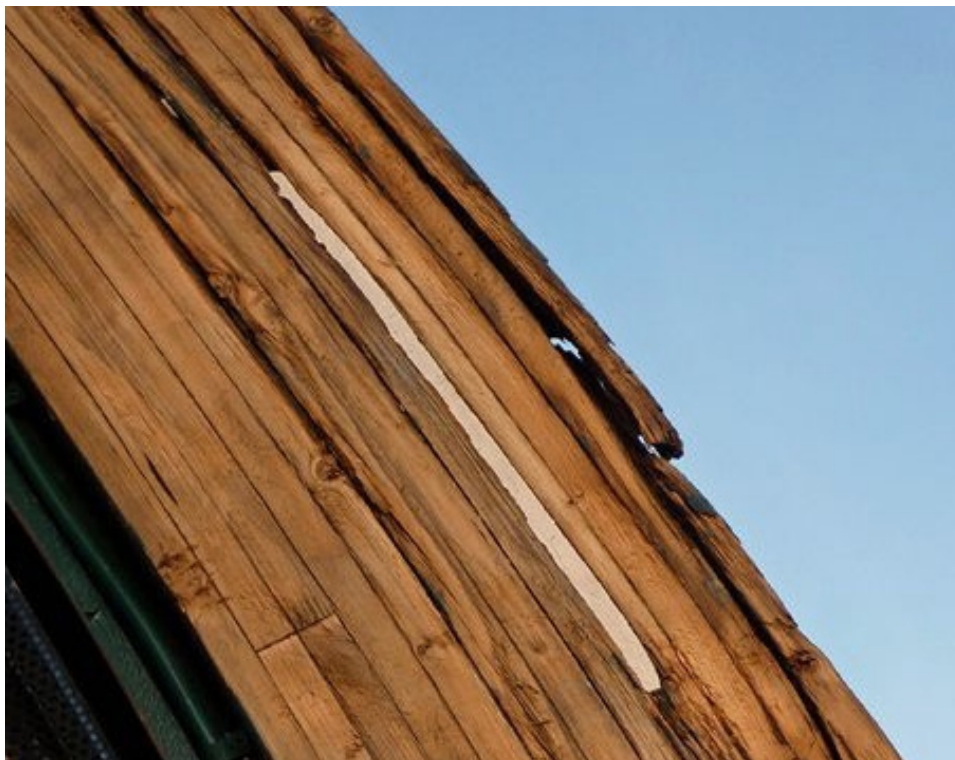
Delaminação de uma viga de MLC (TRAC Structural ltd)
